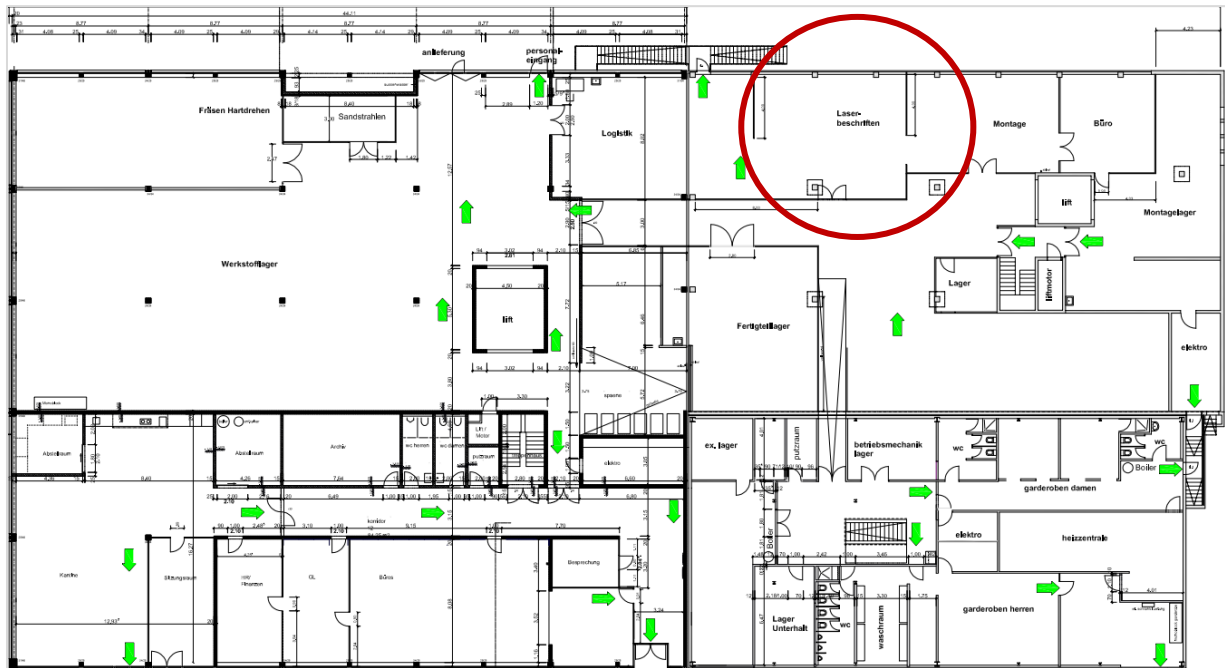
Grundriss Nachbar AG – UG
